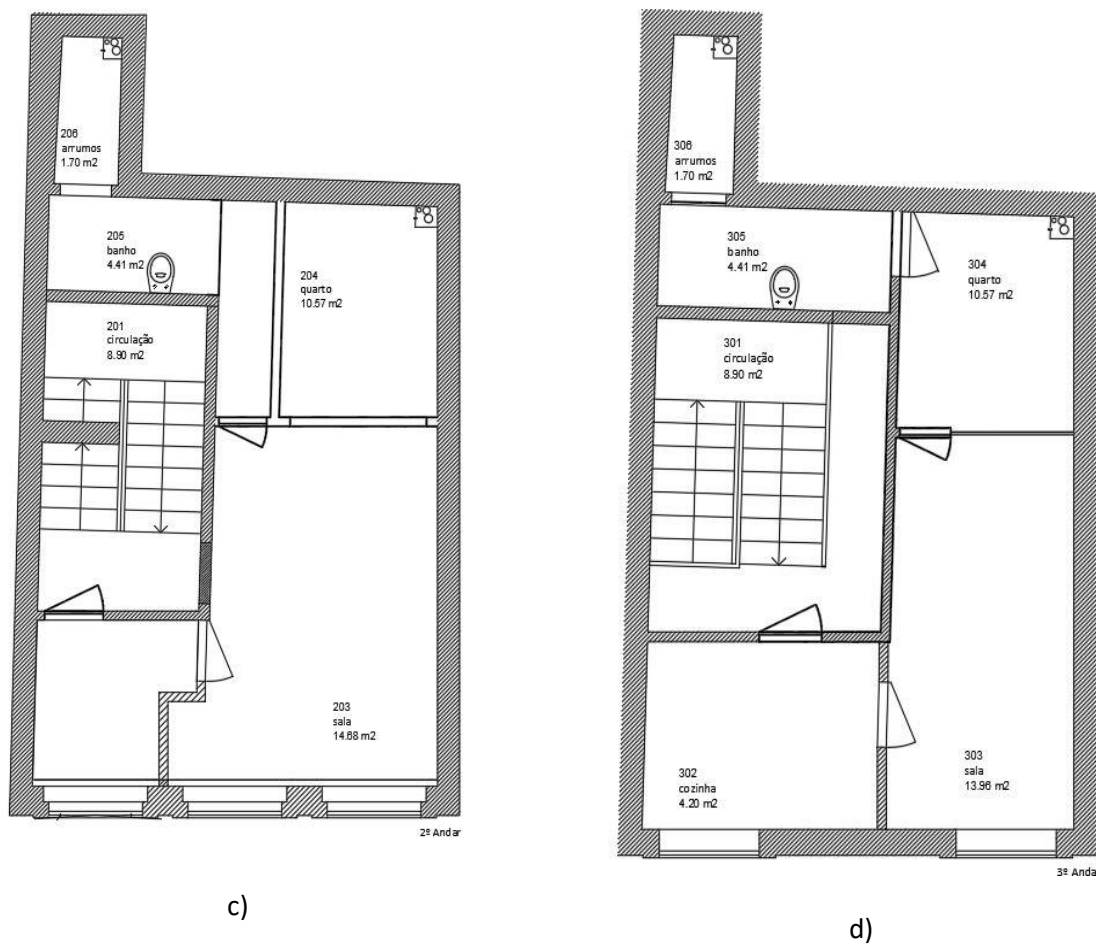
Plantas de arquitetura; c) Planta do 2º piso (Fração em estudo para simulação térmica e acústica); d) Planta do 3º piso.
